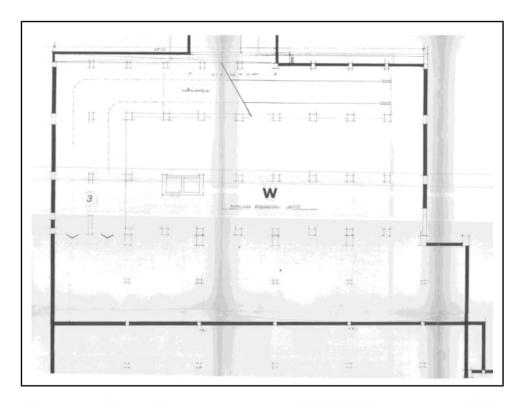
Estratto del grafico di progetto approvato dalla C.E. il 28/12/1983 (concessione 106/1984)
